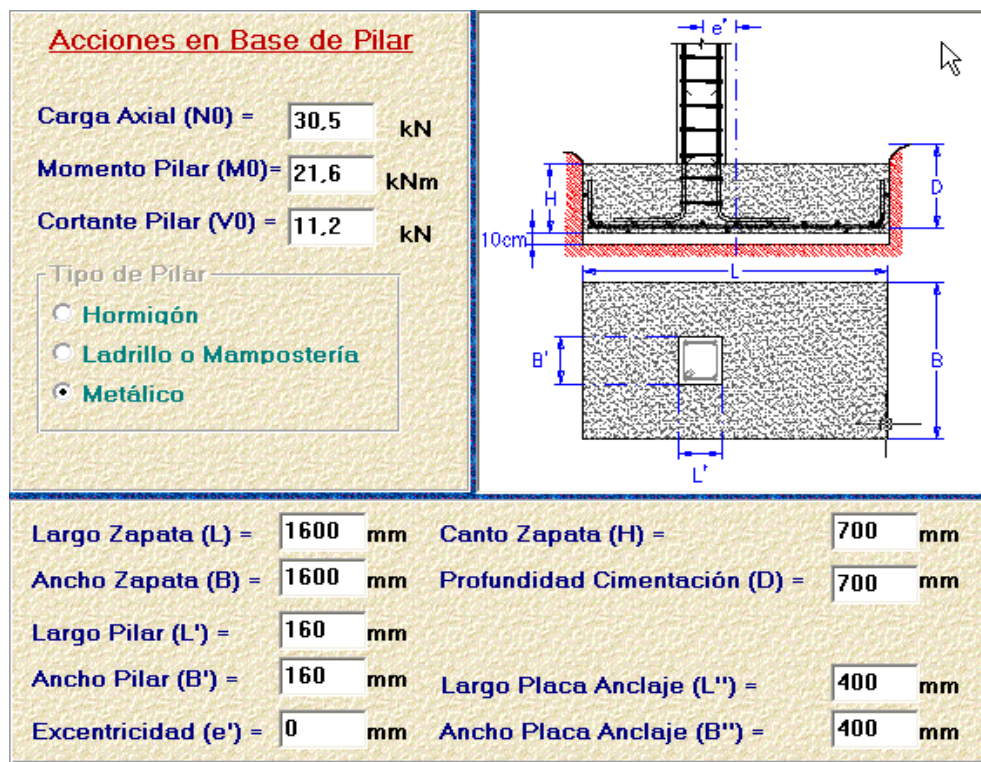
Dimensiones de la zapata 1 (Zapata lateral izquierda del hastial primero)
